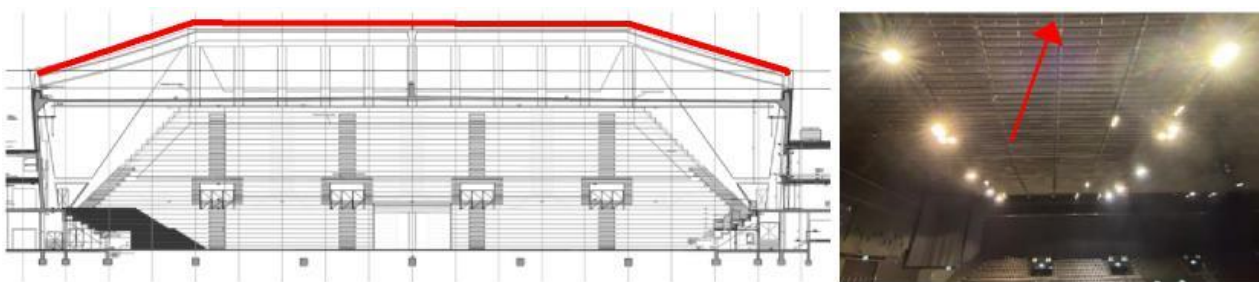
u. 58: Schnitt durch Arena, Decke Arena mit Stahlbänder für temporäre Aufhängungen
